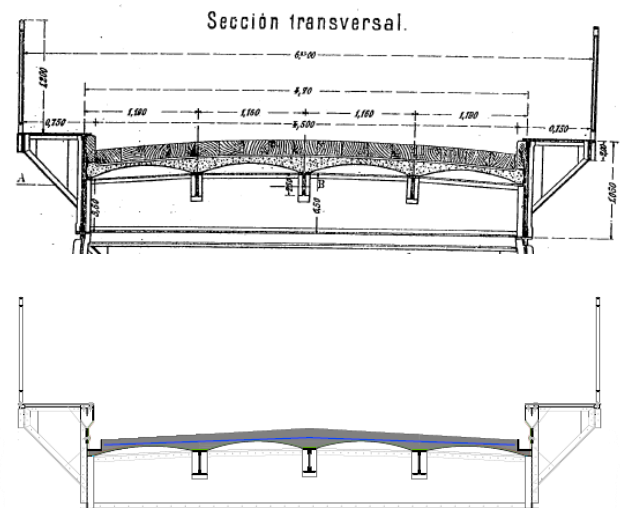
Sección tipo de tablero. Arriba: Tablero definido en Proyecto Original [2]. Abajo: Tablero tras rehabilitación en año 2013.
